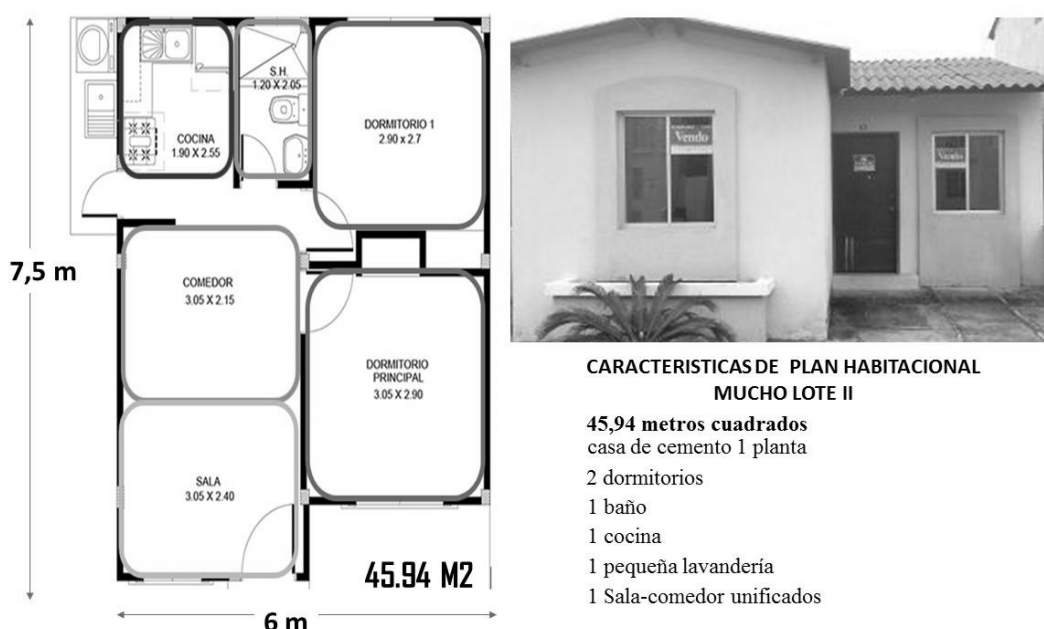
Tipología de la vivienda Mucho Lote 2
